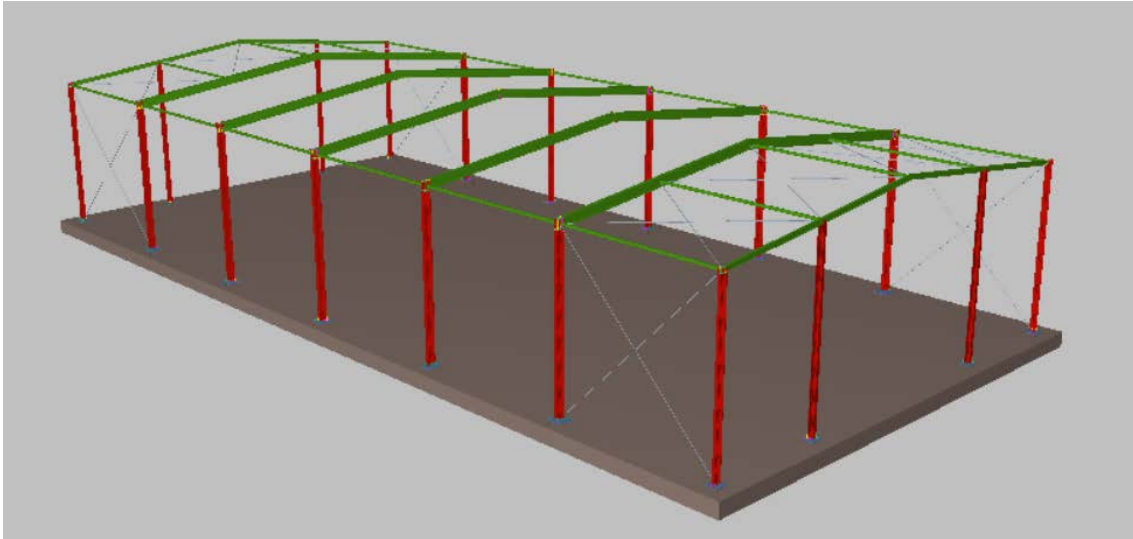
Vista 3D losa de cimentación. Fuente: CYPECAD
